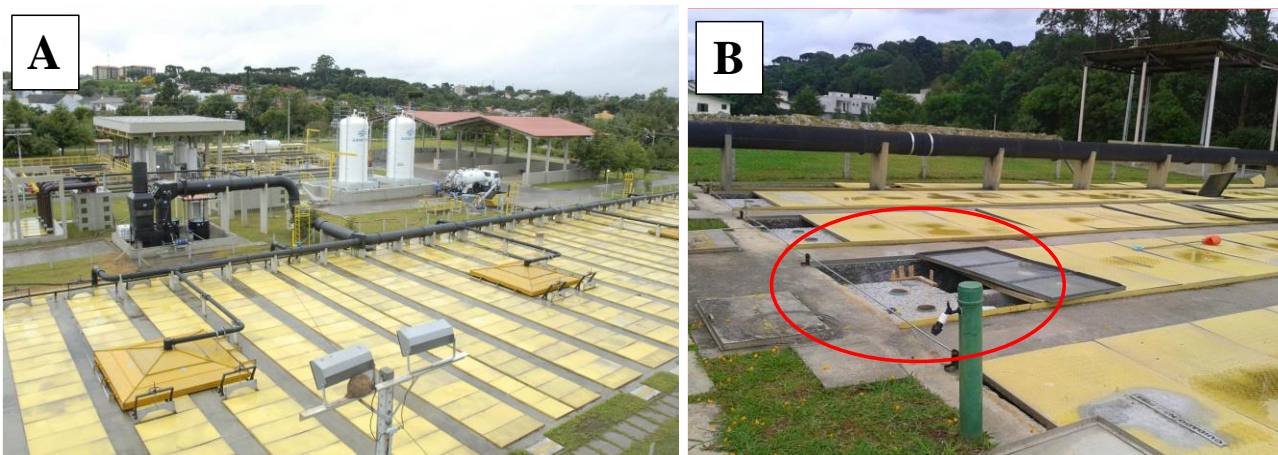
Vista geral da ETE Santa Quitéria (A) e local de retirada de amostras e extração de testemunho da laje (B).
